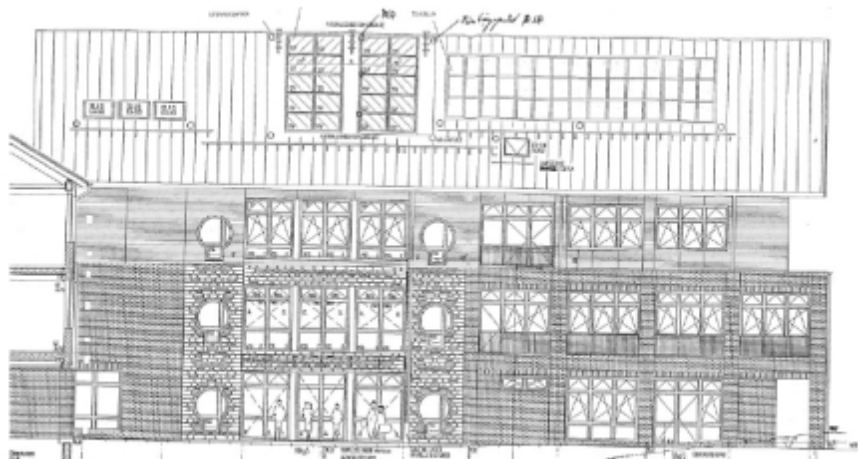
Südansicht Mittelblock Haus A, (Quelle: Ausführungsplan Architekturbüro Grundmann & Partner 09.09.2002)
